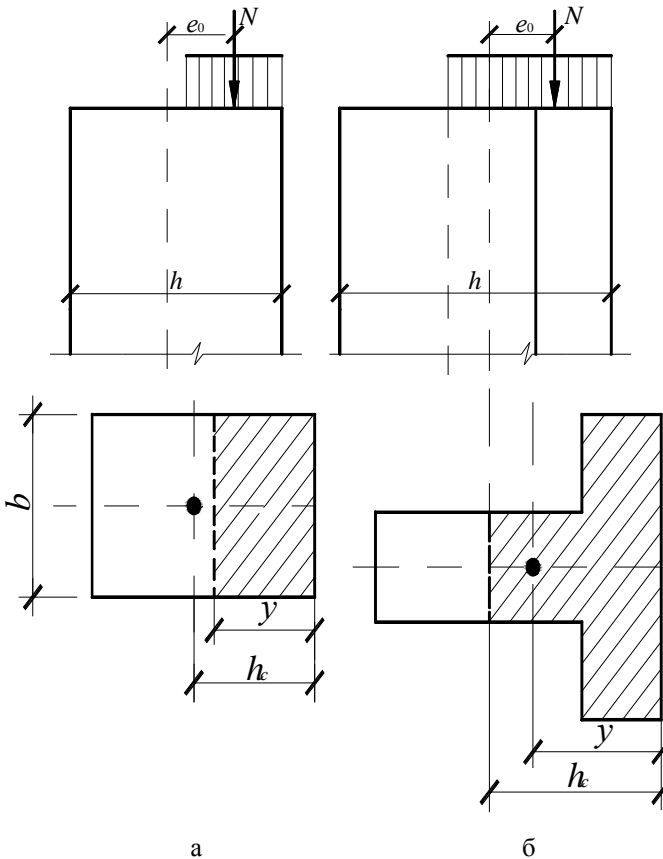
Розрахункова схема при позацифровому стиску кладки:
